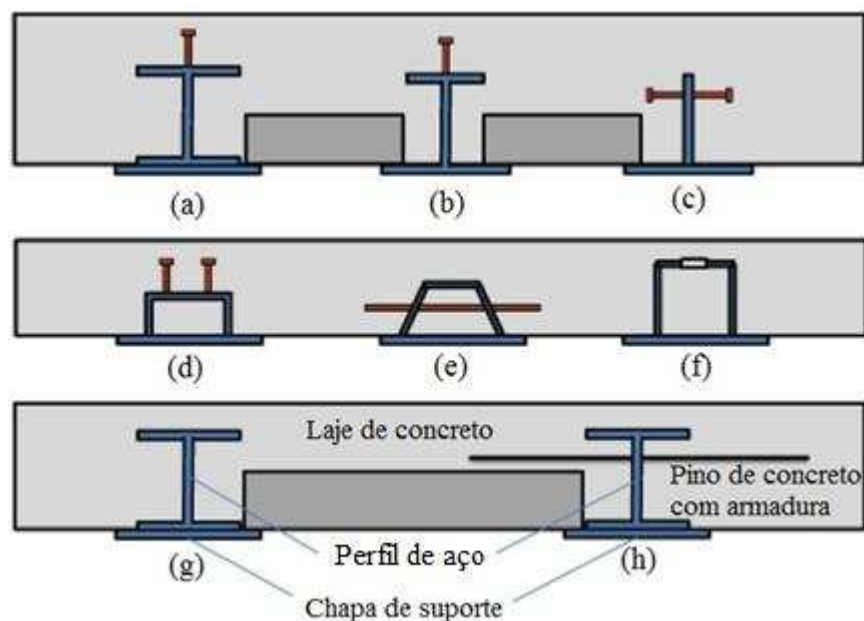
Seções típicas de vigas mistas de *slim floor* (Adaptado de HAUF e KUHLMANN, 2015).
